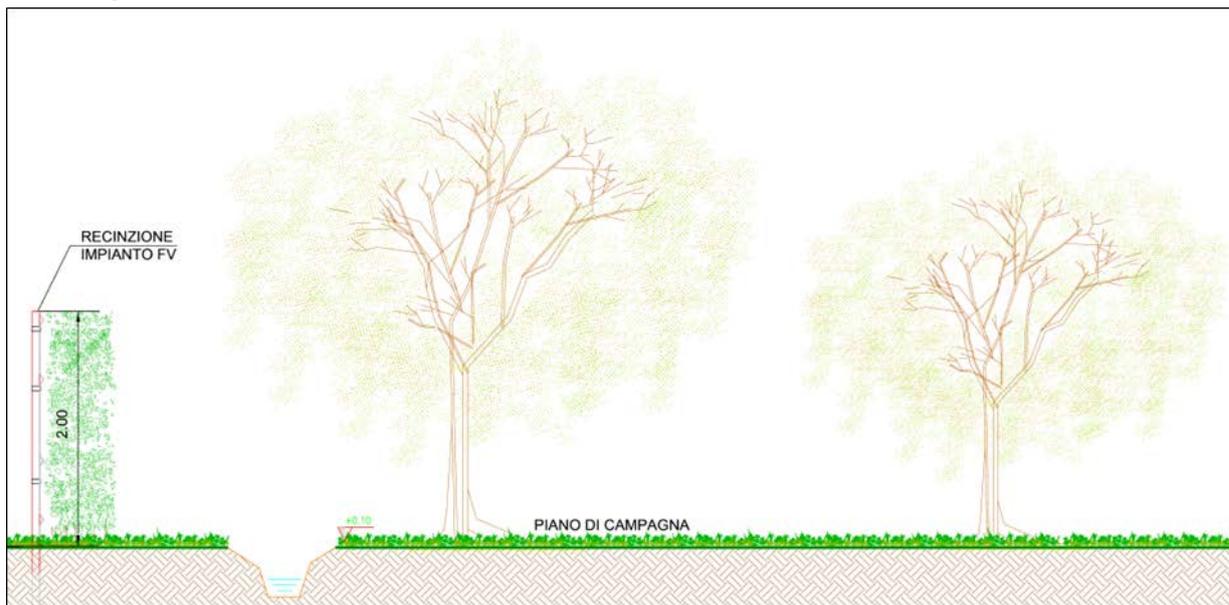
Sezione tipologica fascia di mitigazione perimetrale
